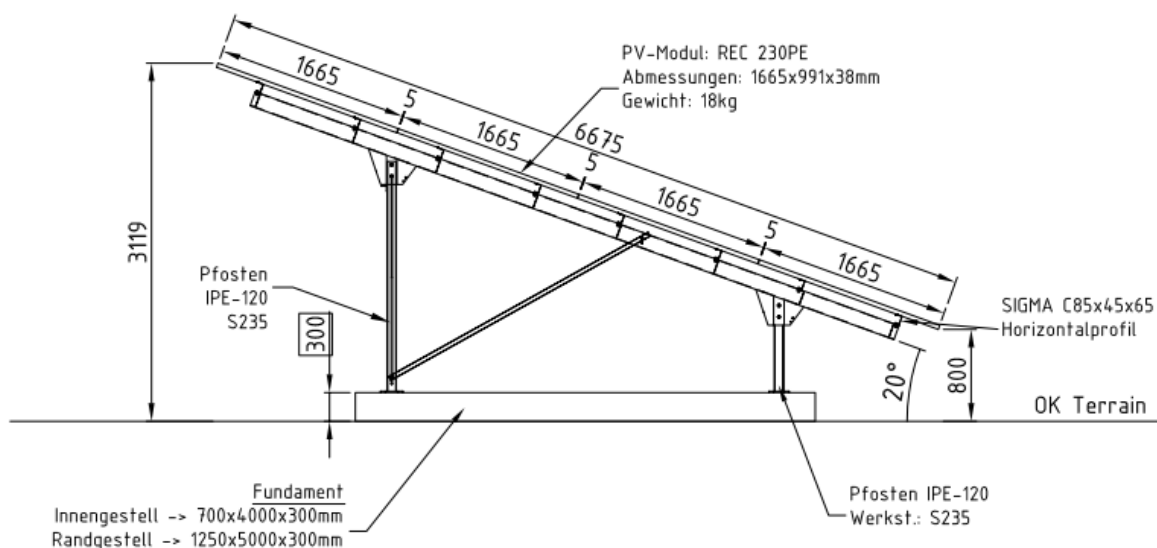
Gründungsvariante 1 – Betonstreifenfundament
